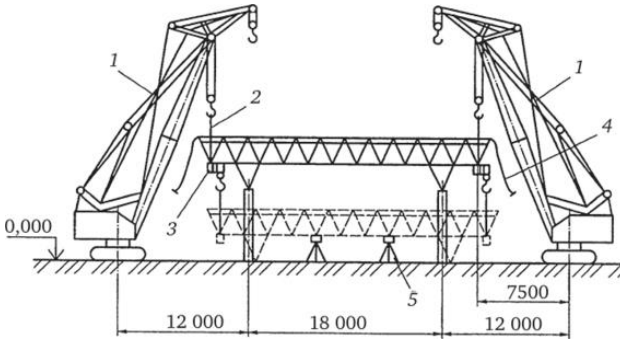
Схема монтажа блока покрытия двумя кранами:
